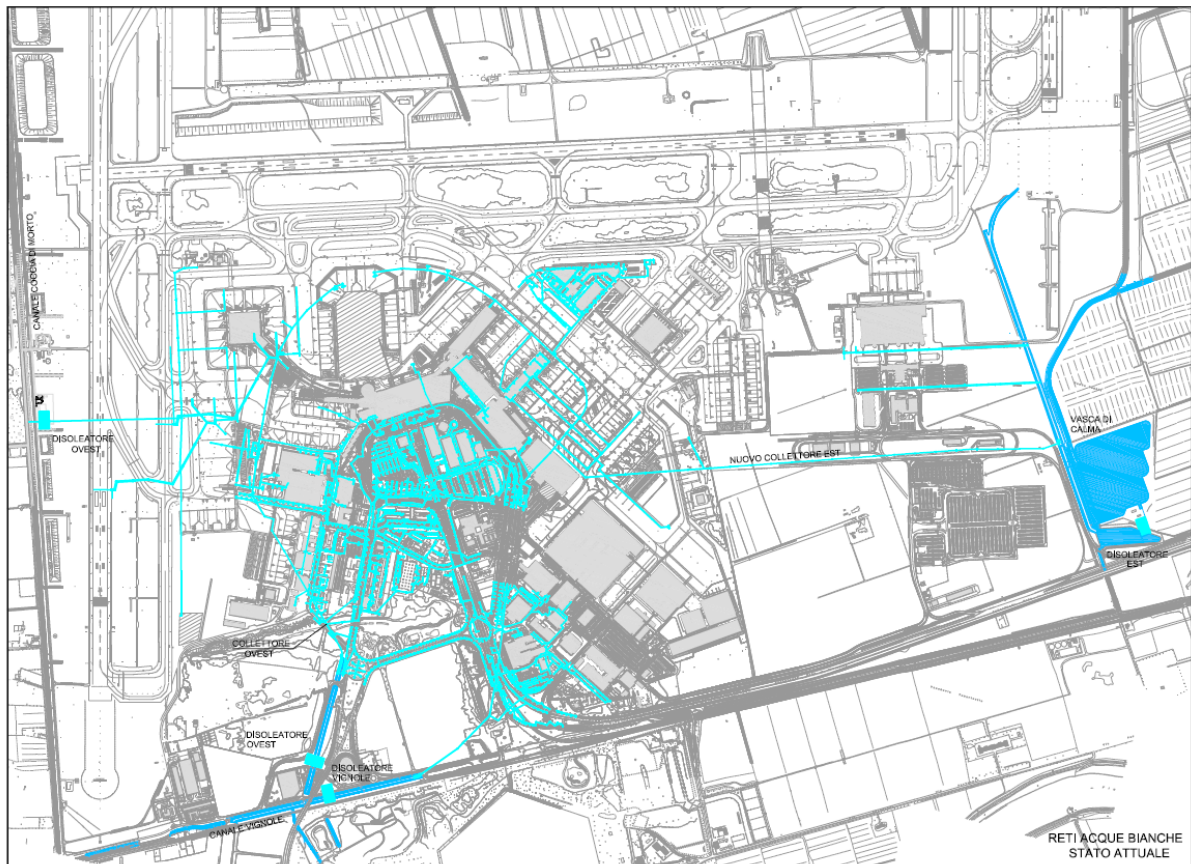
Planimetria delle reti di scarico delle acque bianche
